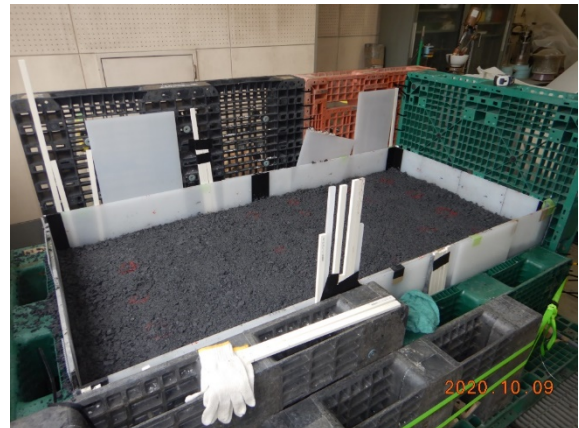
下層路盤 (クラッシュラン) 施工
